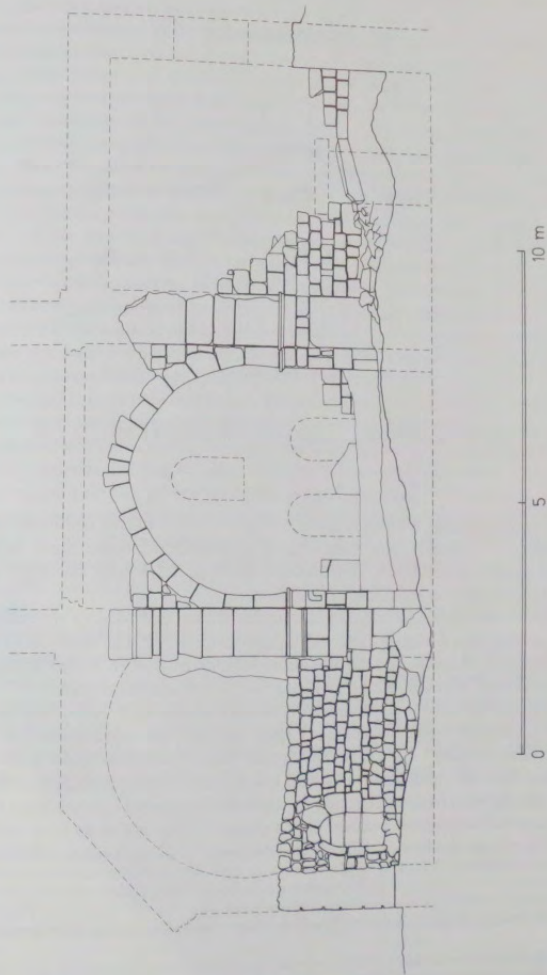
Kirche 2, Längsschnitt mit Blick nach Süden. M 1:100
